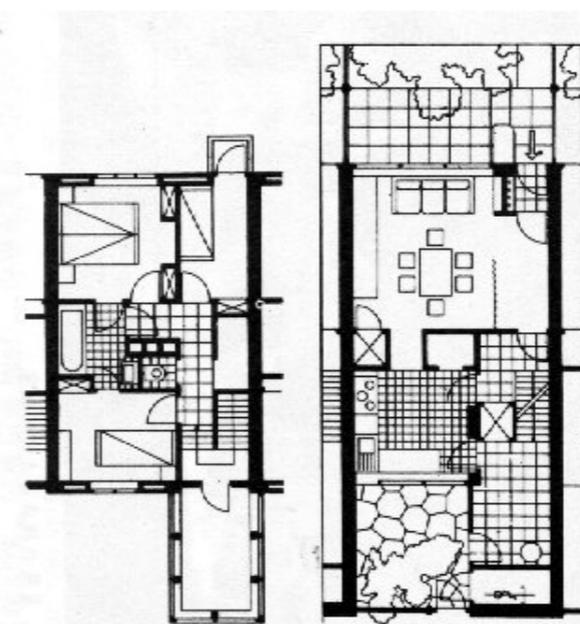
J.J.P.Oud, Reihenhaus Weißenhofsiedlung, Grundrisse Erdgeschoß und Obergeschoß
